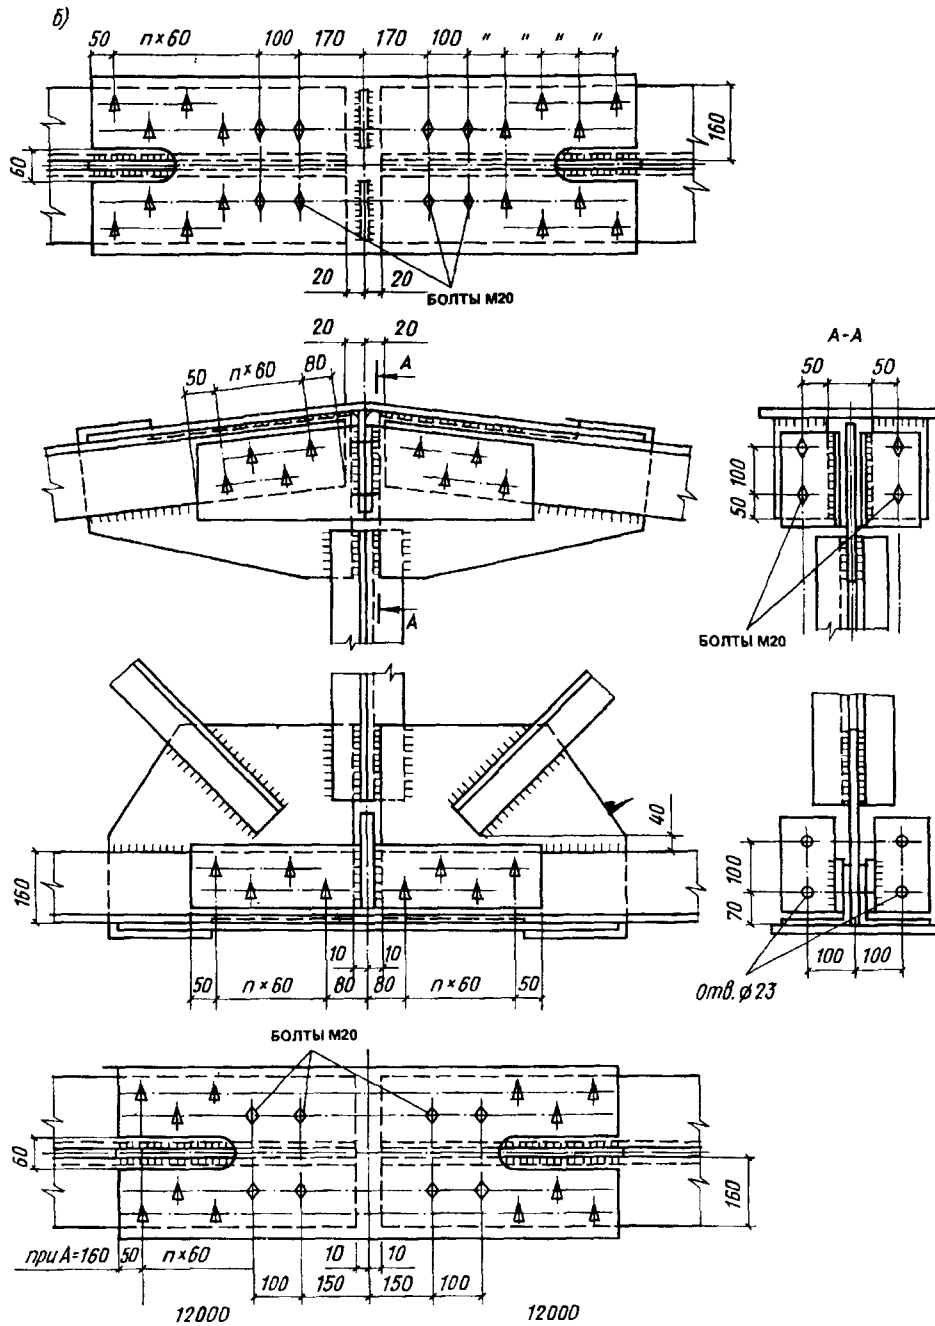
Укрупнительный стык стропильной фермы из парных уголков
